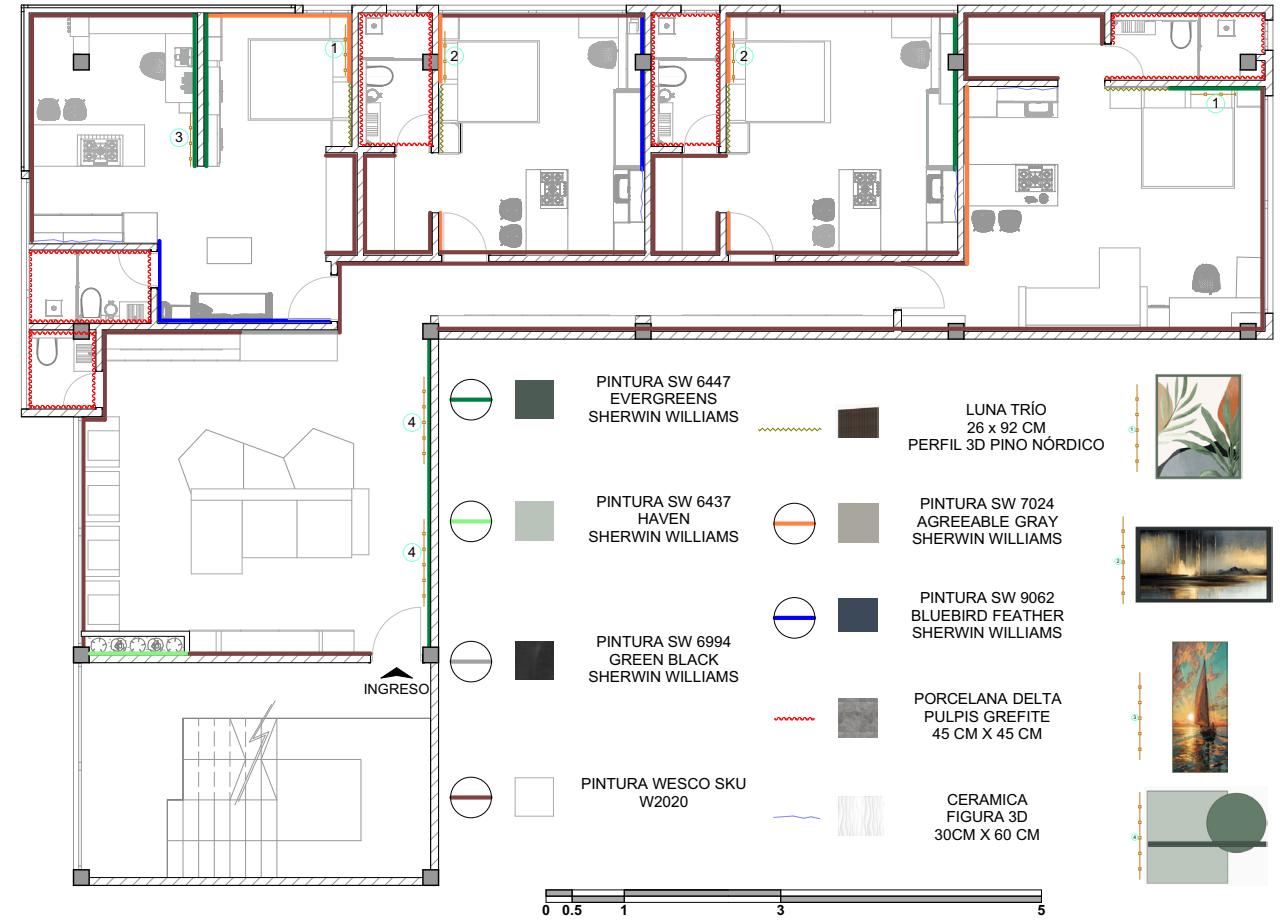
Autoría Jose Cruz. Plano de pisos
